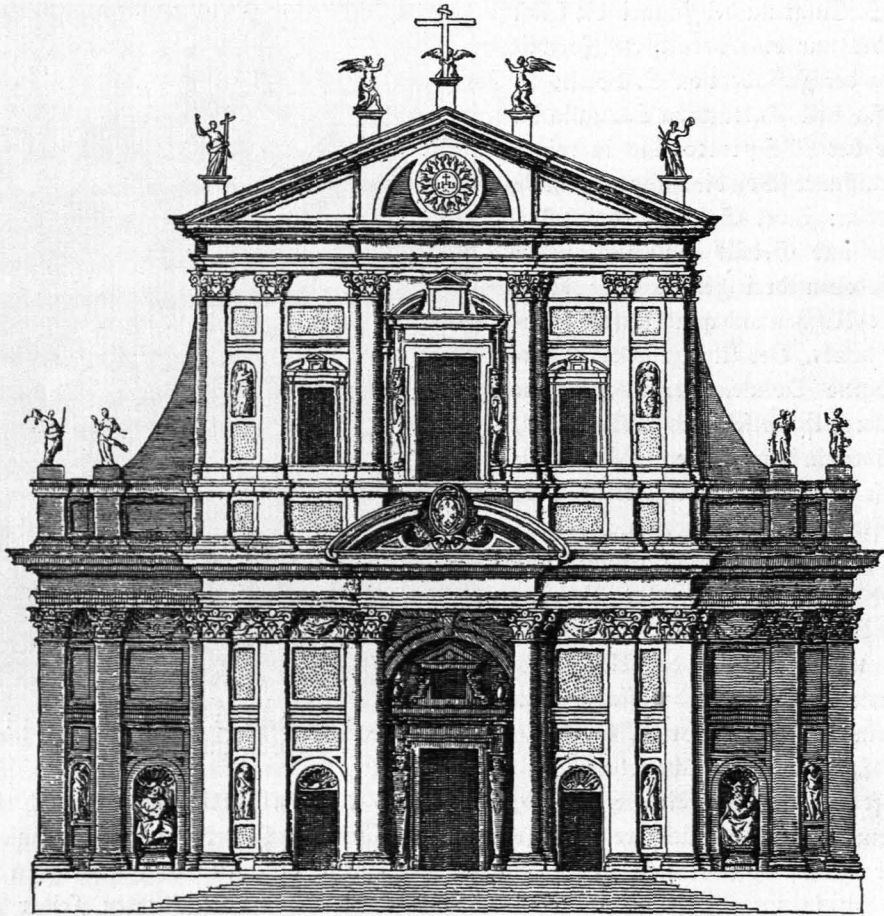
Vignola, Entwurf zur Fassade des Gesù
